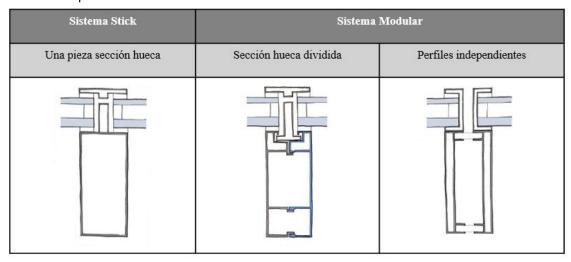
Croquis de sección de montantes de sistemas de muro cortina
